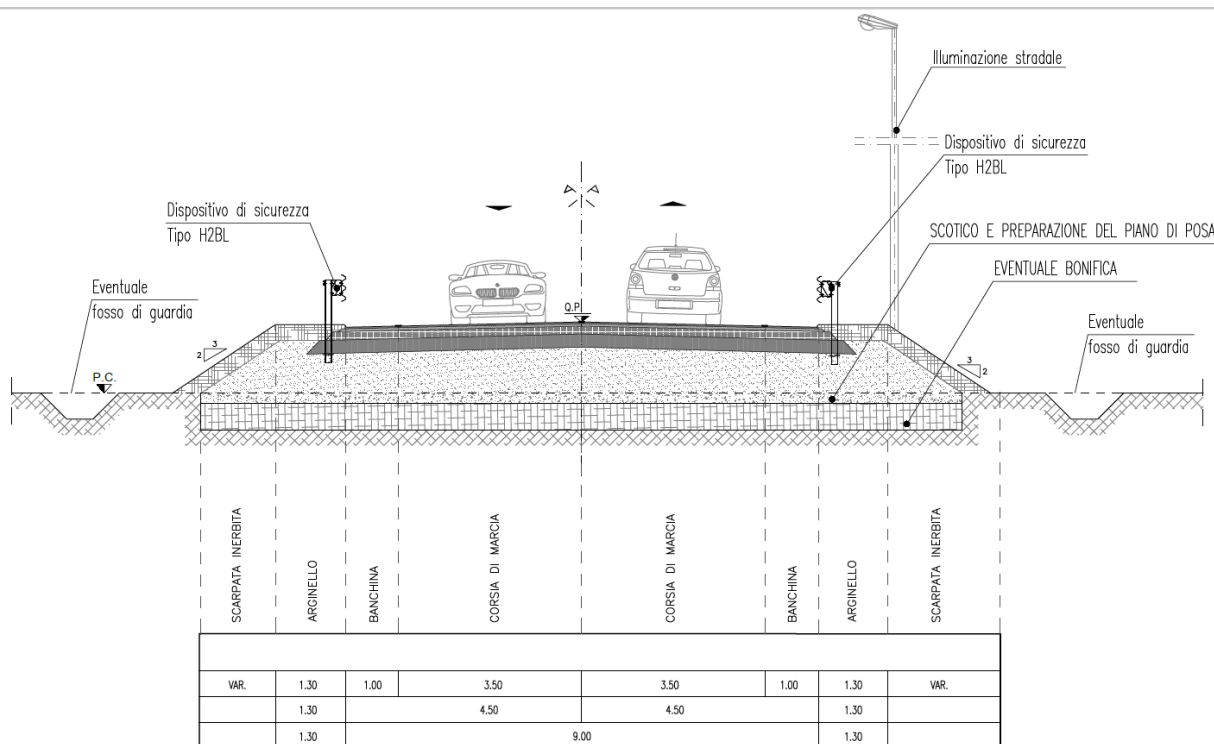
Sezione stradale rampa a doppio senso di circolazione
